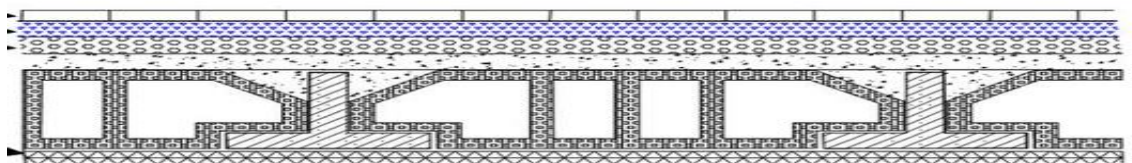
les différent couche de plancher terrasse accessible (COUR B.A ENSET)
